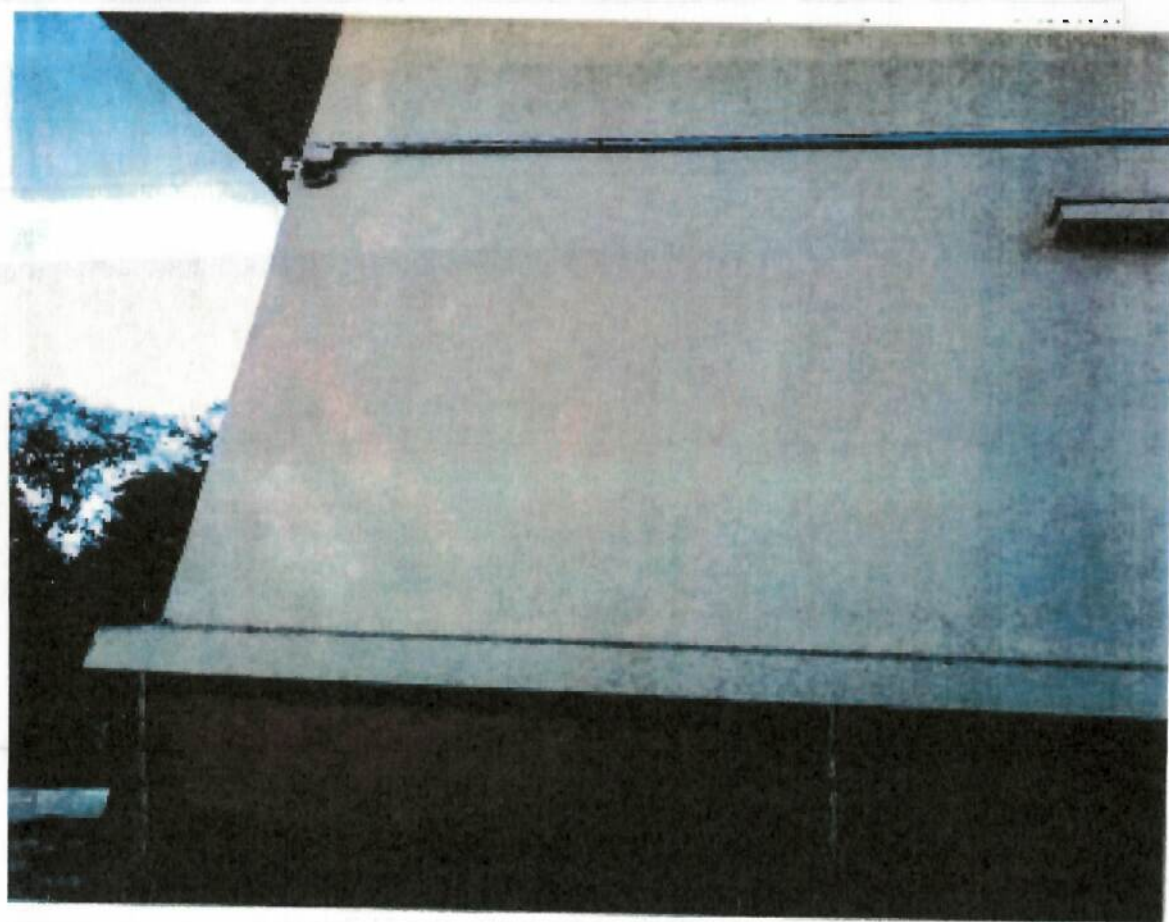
Situație existentă – Fisuri verticale și înclinată în parapet zona curba, parter, Corp C1-Tronson A
